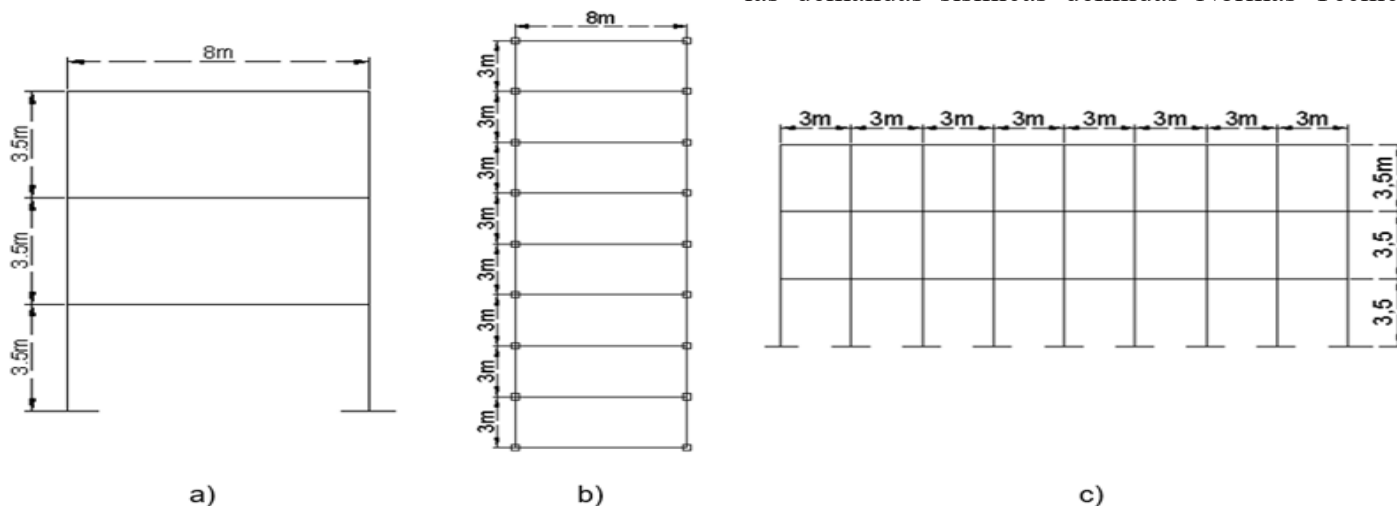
Geometría de las estructuras estudiadas a) Elevación lateral, b) Planta, c) Elevación frontal
